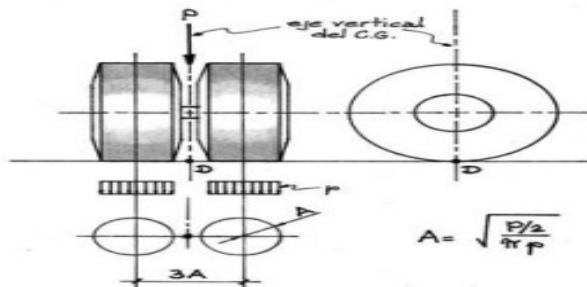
Punto de colocación en el extremo de la viga Benkelman
